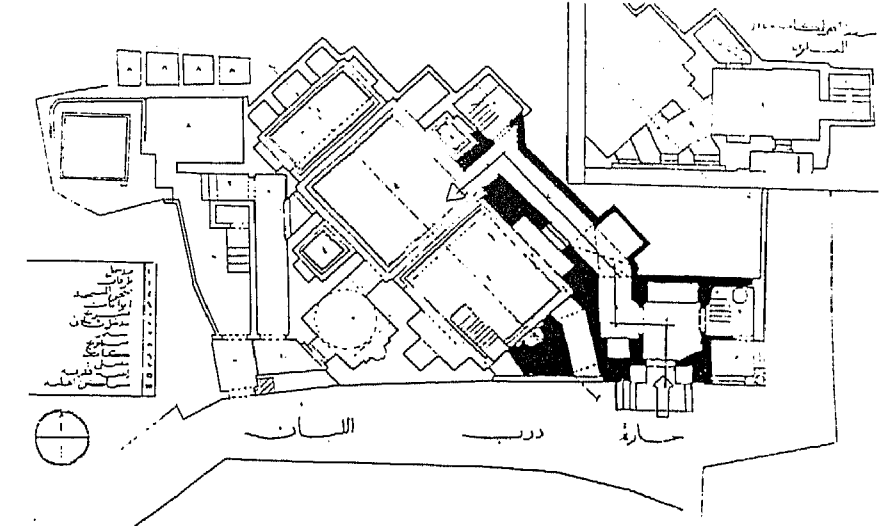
مسقط أفقى لمدخل جامع جوهر اللالا
